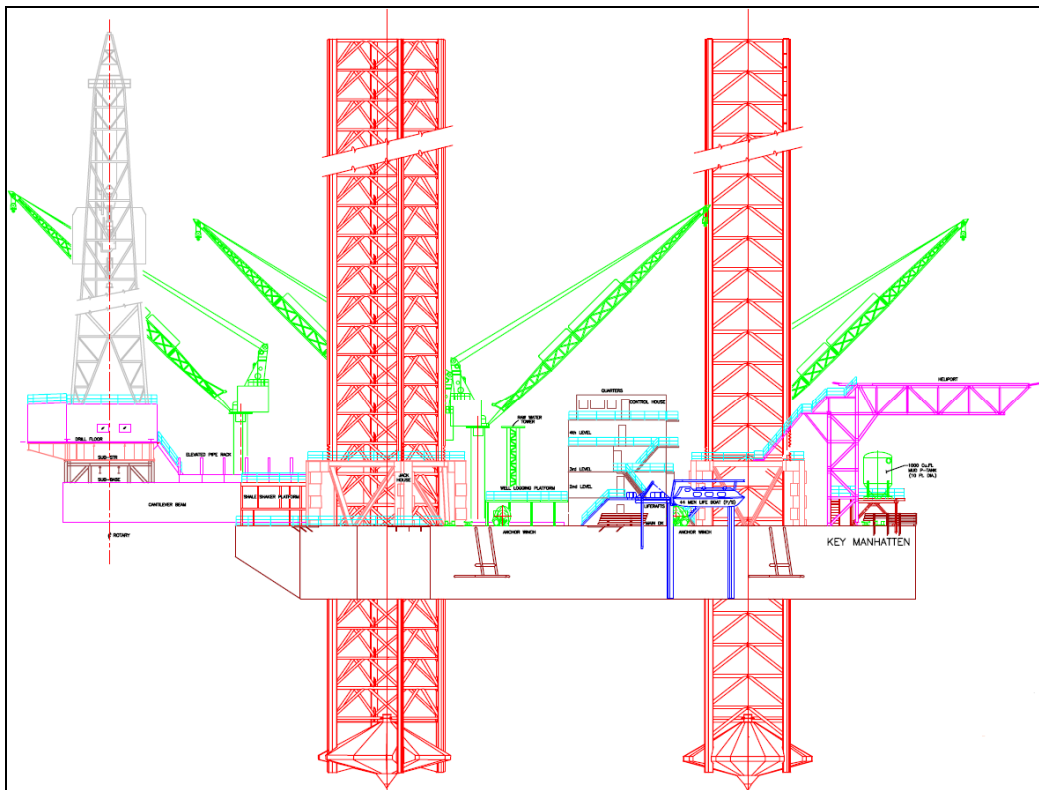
planimetria Impianto Jack-Up Drilling Unit (GSF Key Manhattan - Vista laterale del piano motori, pompe, vasche)
